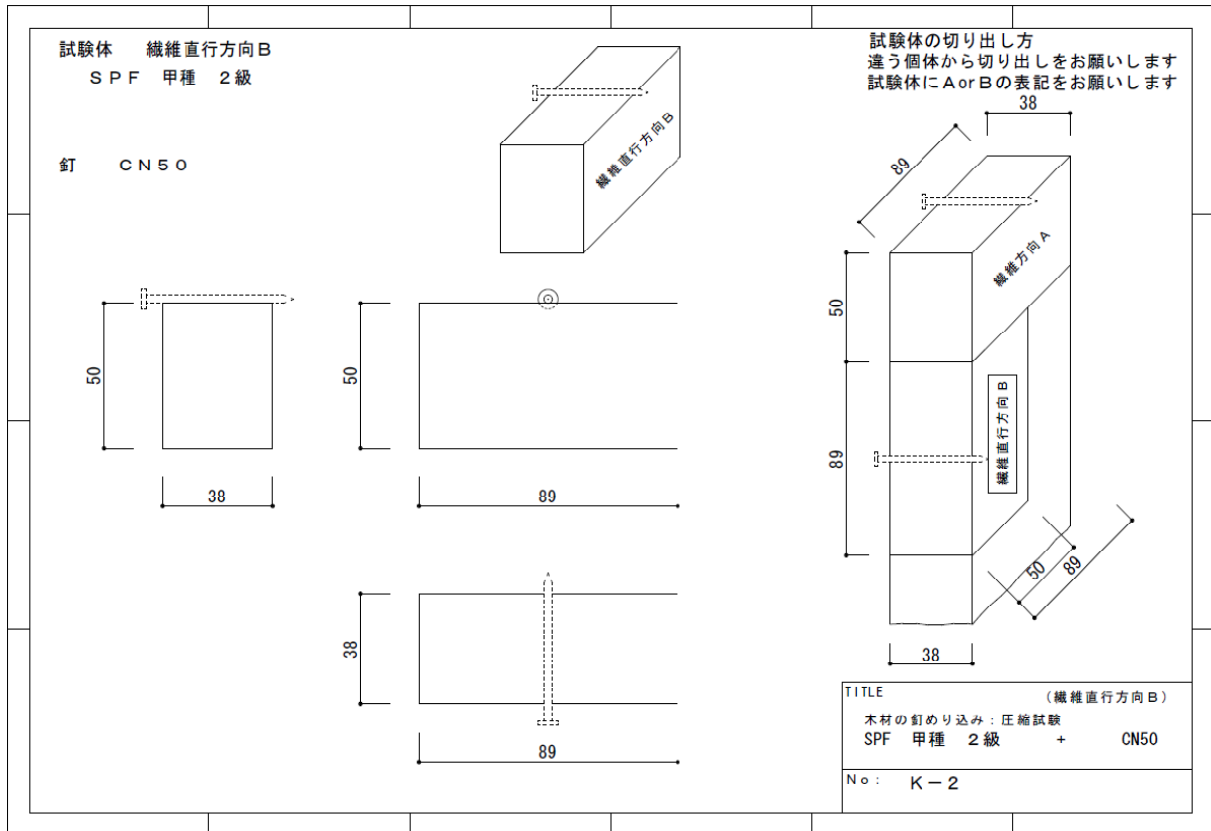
K-2 試験体図 (SPF 甲種 2級)
